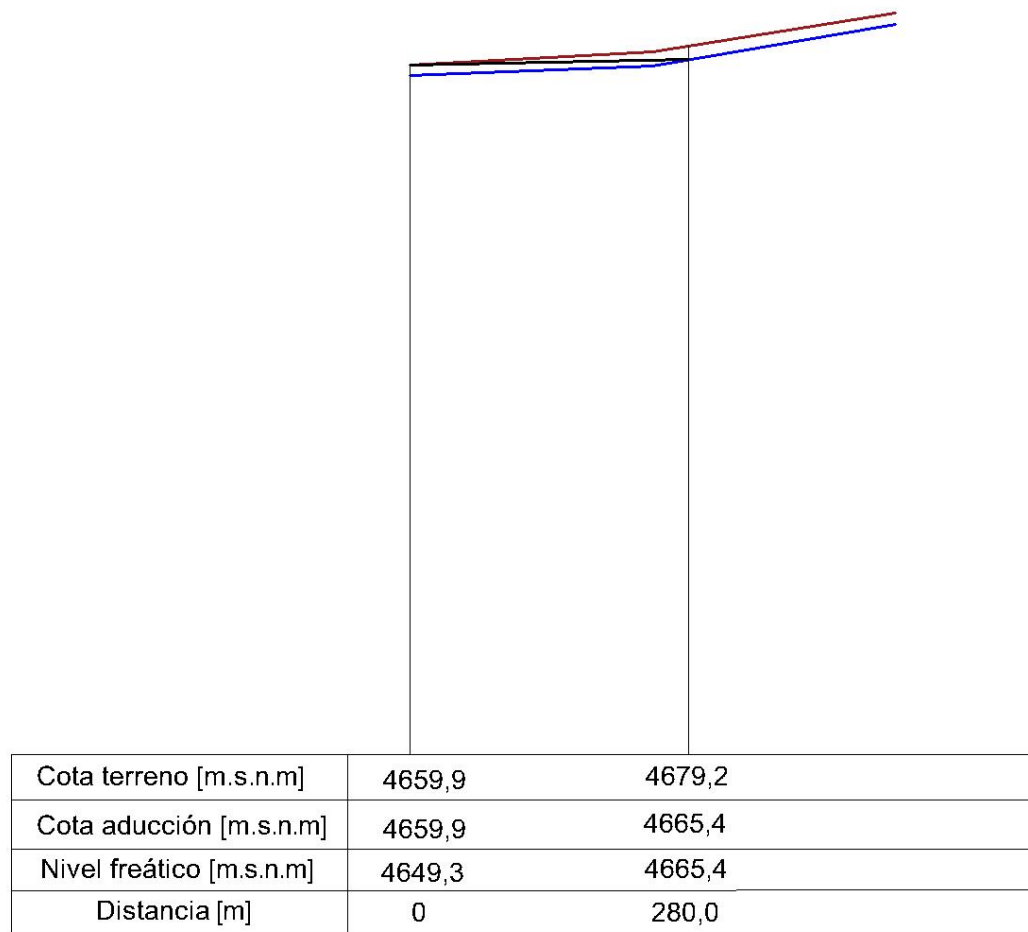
Perfil longitudinal de aducción en Quebrada 12.
